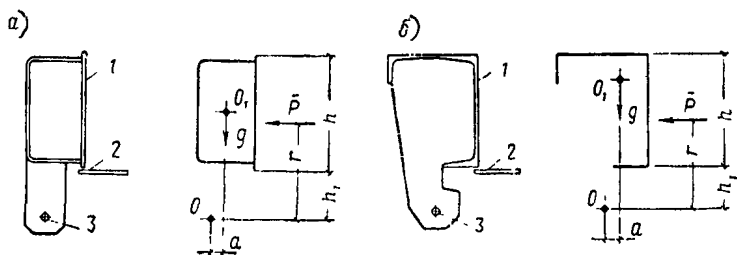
Расчетные схемы борта при шарнирном креплении к поддону
